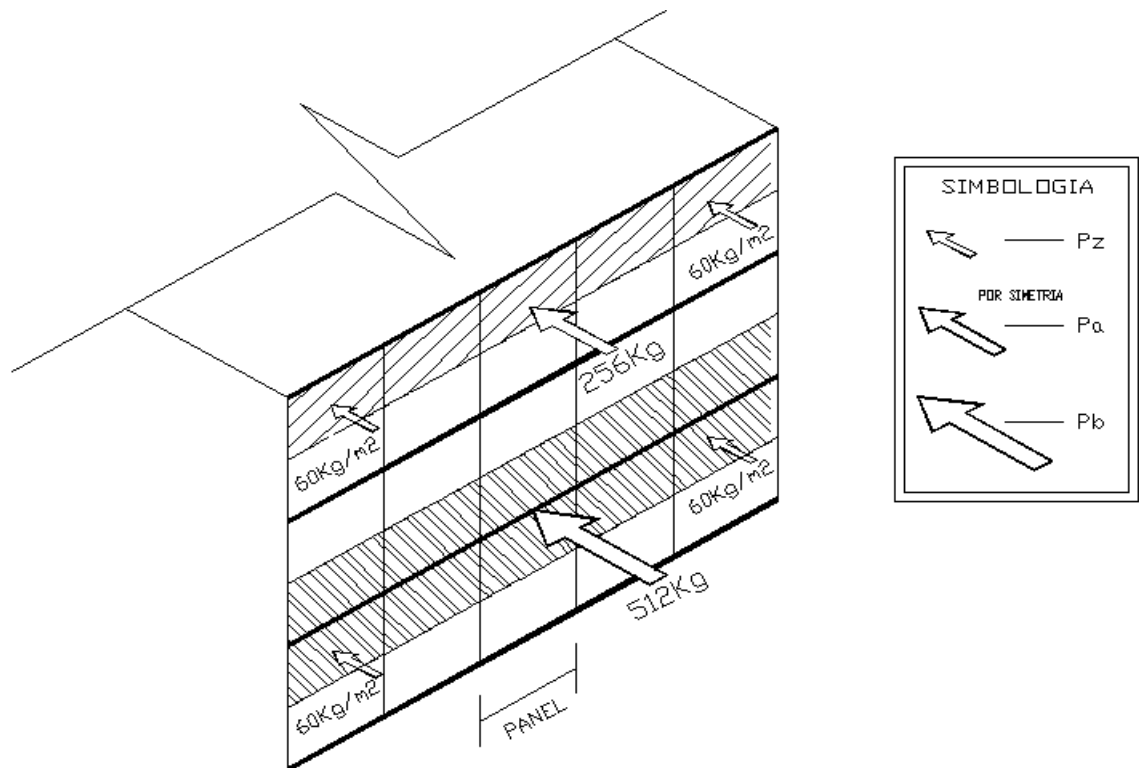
Isométrico de cargas actuantes en columnas de estructura metálica.
